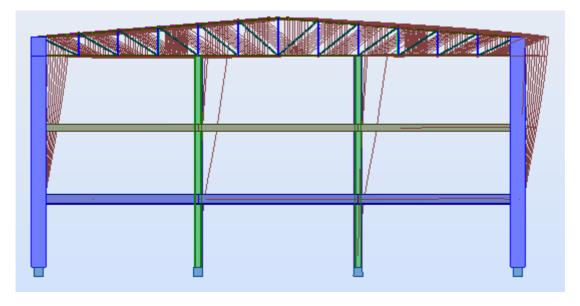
Le déplacement avec prolongement des poteaux.
